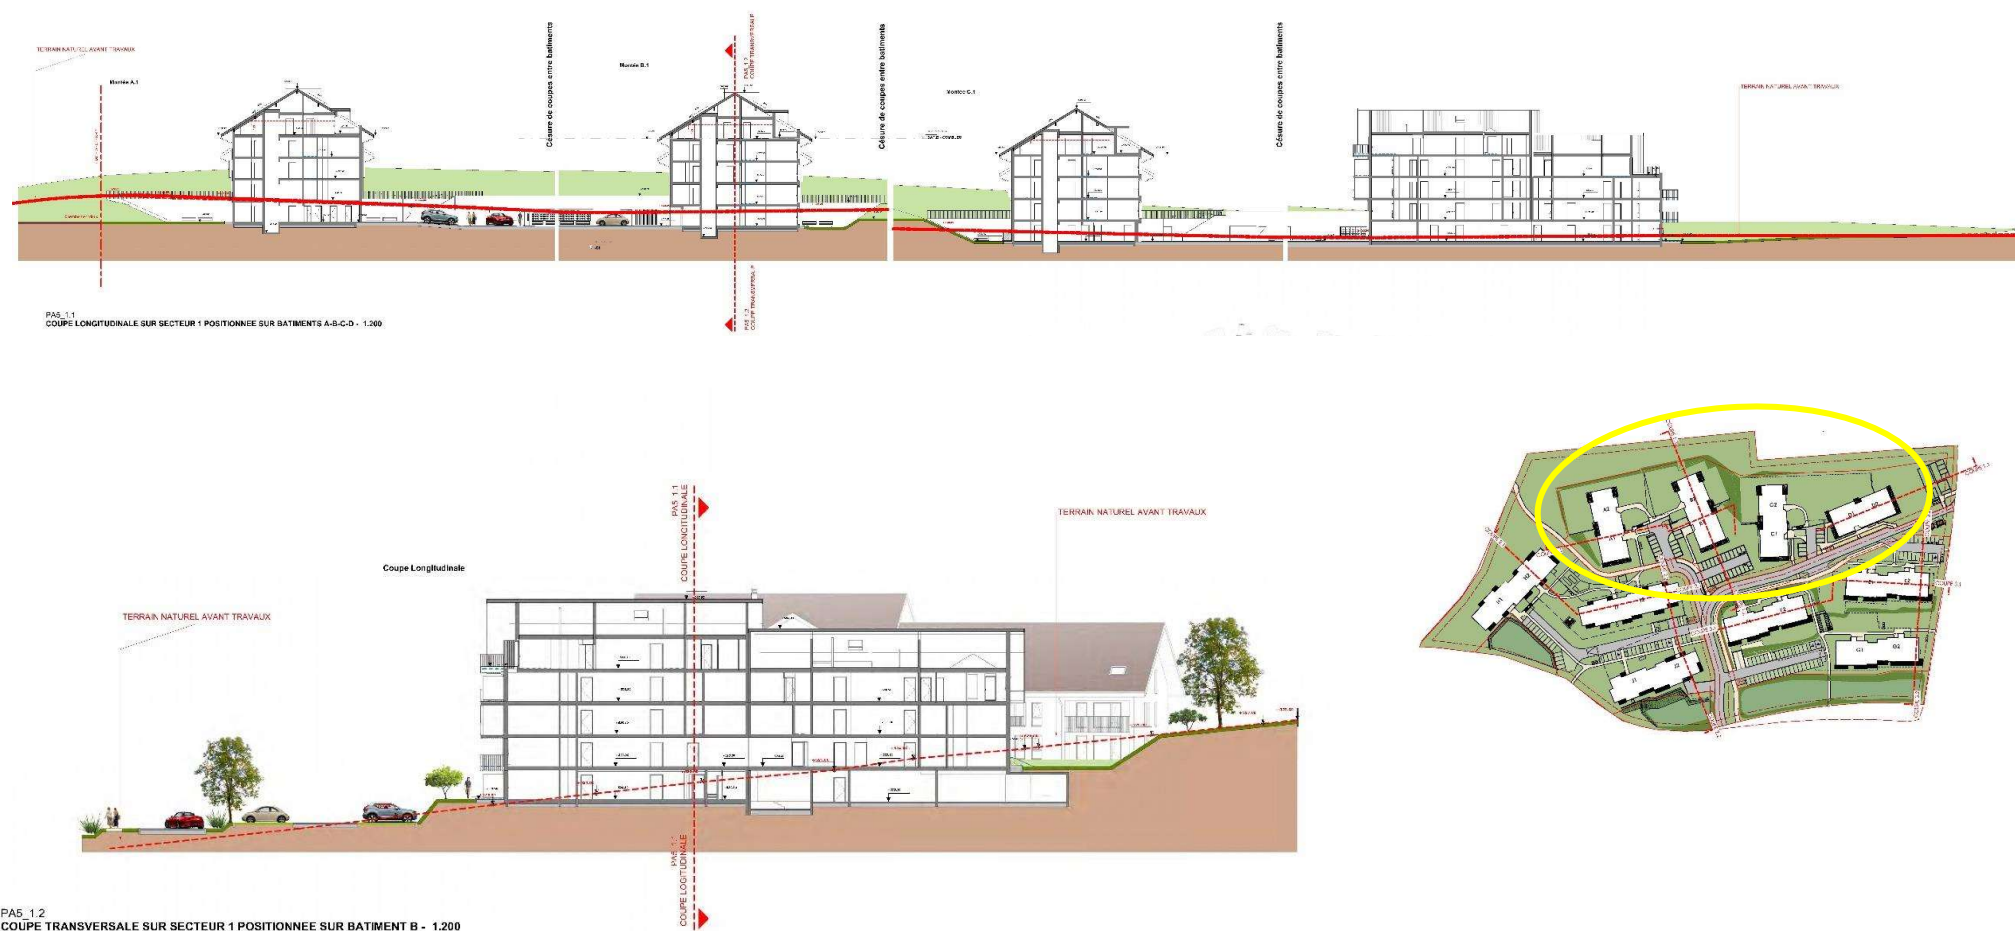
Coupe longitudinale sur les 4 bâtiments du secteur 1 et coupe transversale sur le bâtiment B
